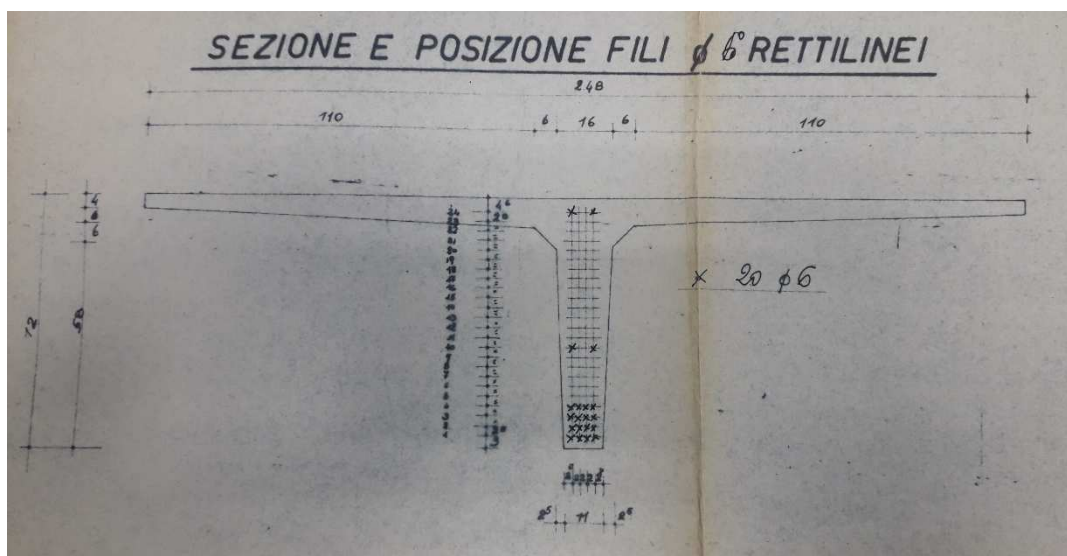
Foto della sezione della trave prefabbricata di copertura con l'armatura di precompressione a fili aderenti.
